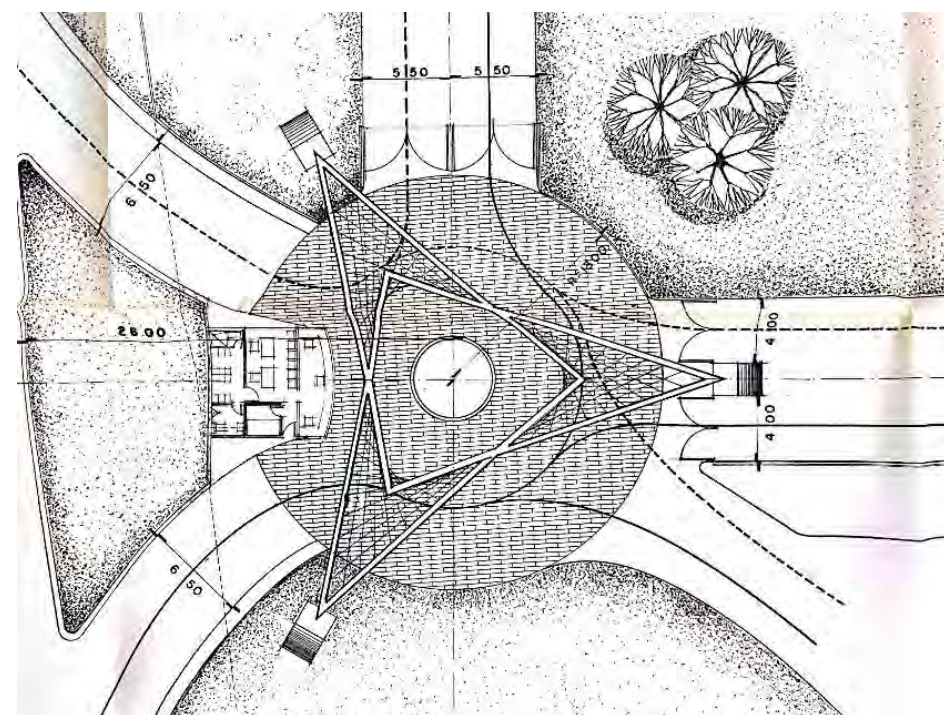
Planta Estructura de acceso conjunto Bacardí Detalle
